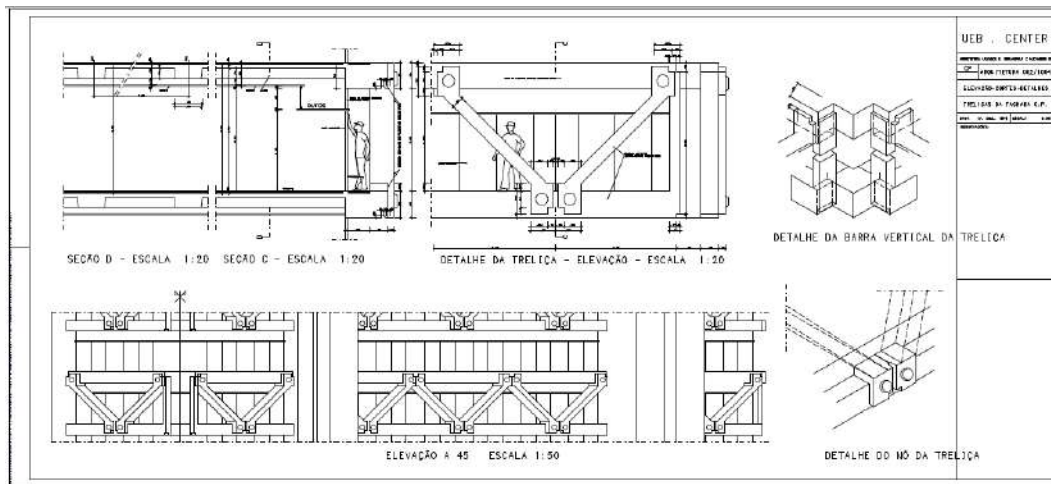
Torre Rio Sul. Detalhes da treliça de fachada.
